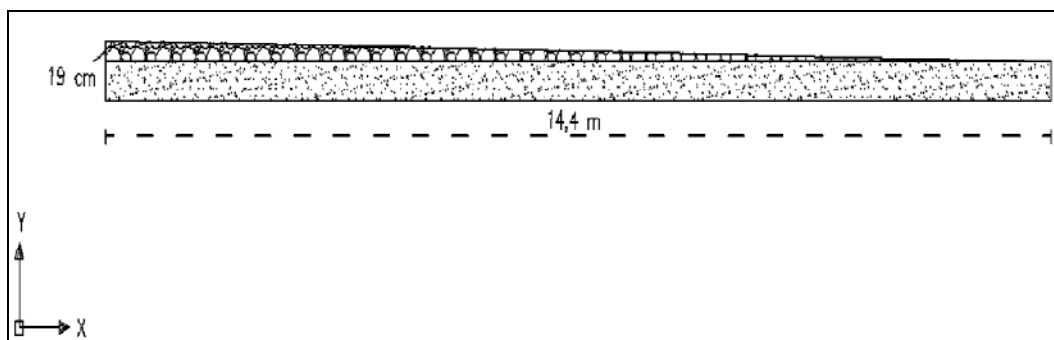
Cross Fall Minimum Jalan Tambang
